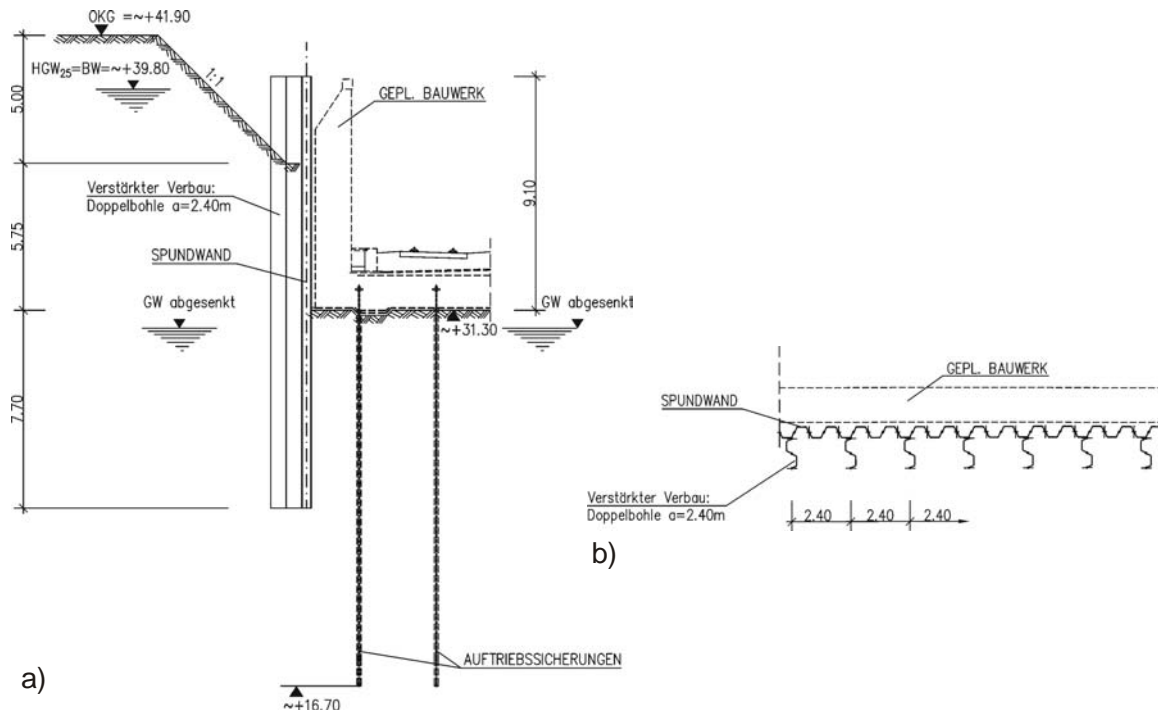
Baugrubenkonstruktion Typ 3 - verstärkter Verbau als freistehende und im Baugrund eingespannte Spundwand; Bild 9a) Schnittdarstellung; Bild 9b) Grundrissausschnitt
